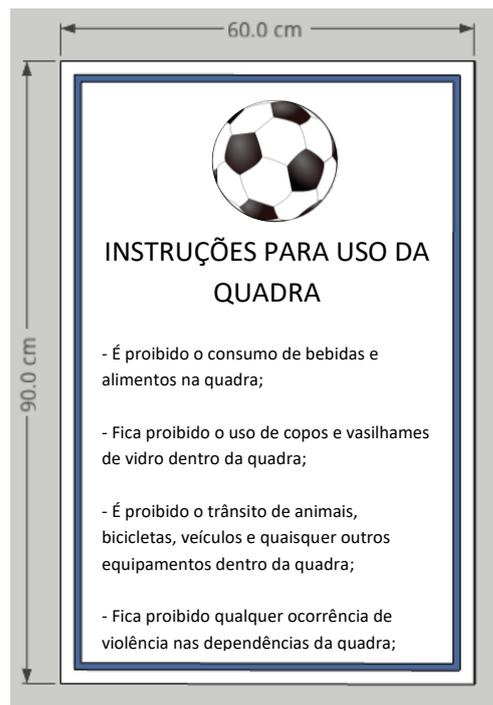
Detalhe Ilustrativo de placa de instruções (Fonte: Autor/2023)
